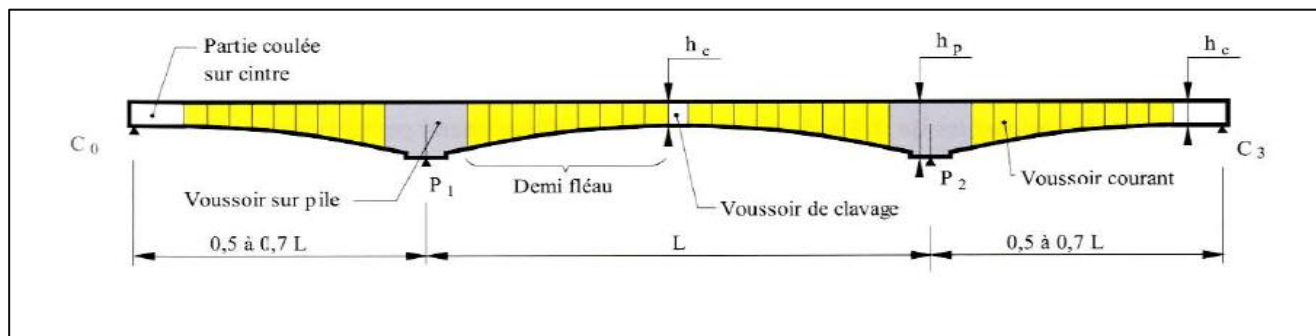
Schéma d'une coupe longitudinale de la variante 3
